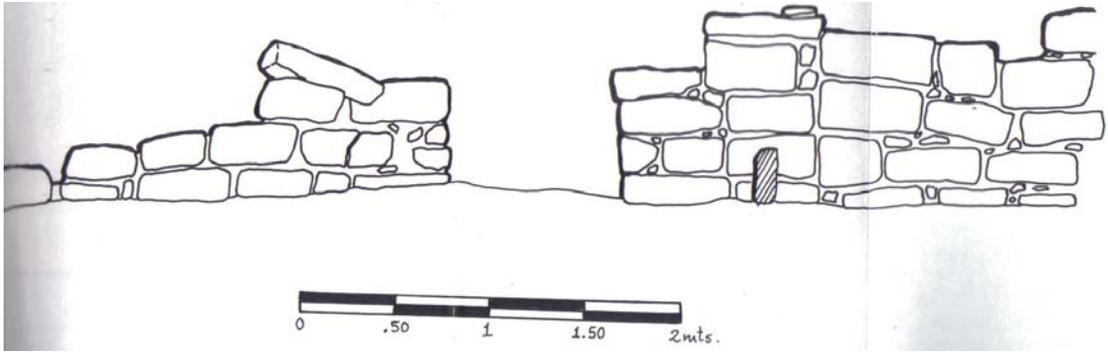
Alzado del muro Este de la Construcción Superior.
